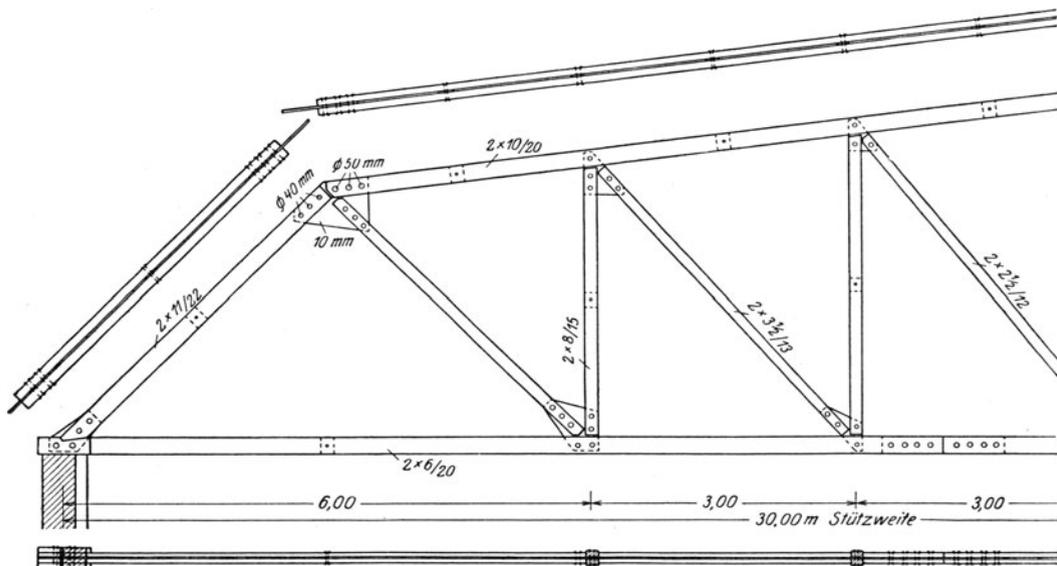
Fachwerkbinder mit eisernen Knotenblechen.
